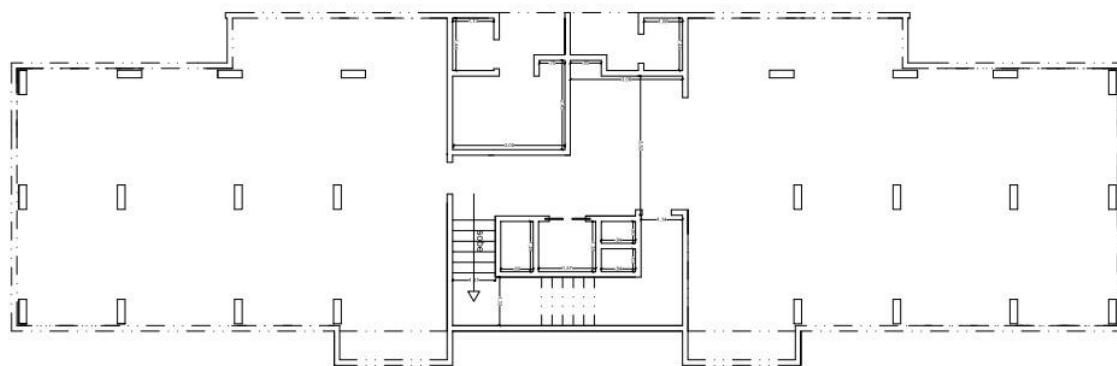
Planta baixa (croqui) do Térreo (Blocos B e C)
